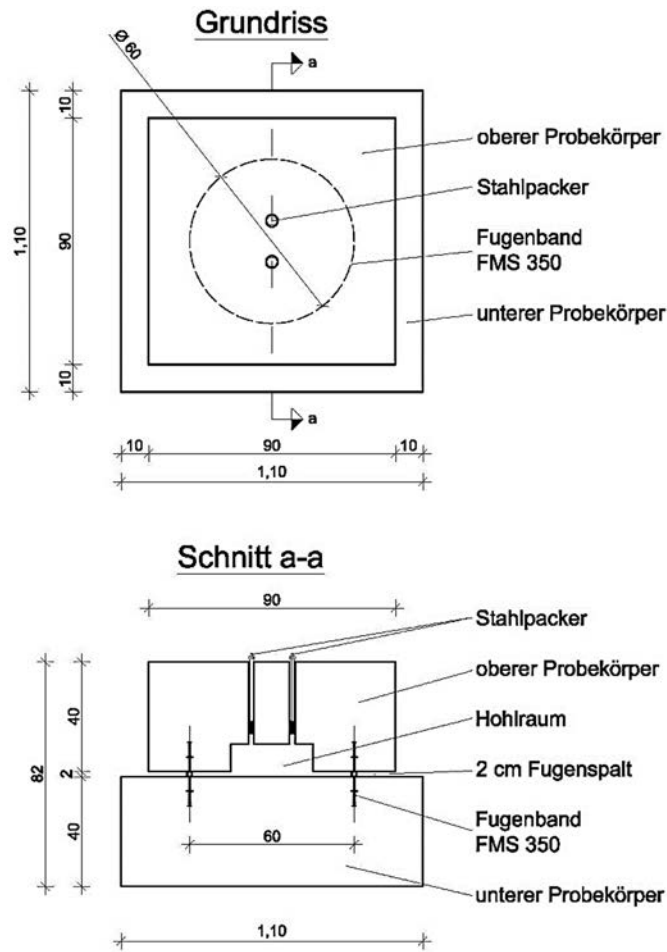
Schema Prüfkonstruktion Bewegungsfuge
